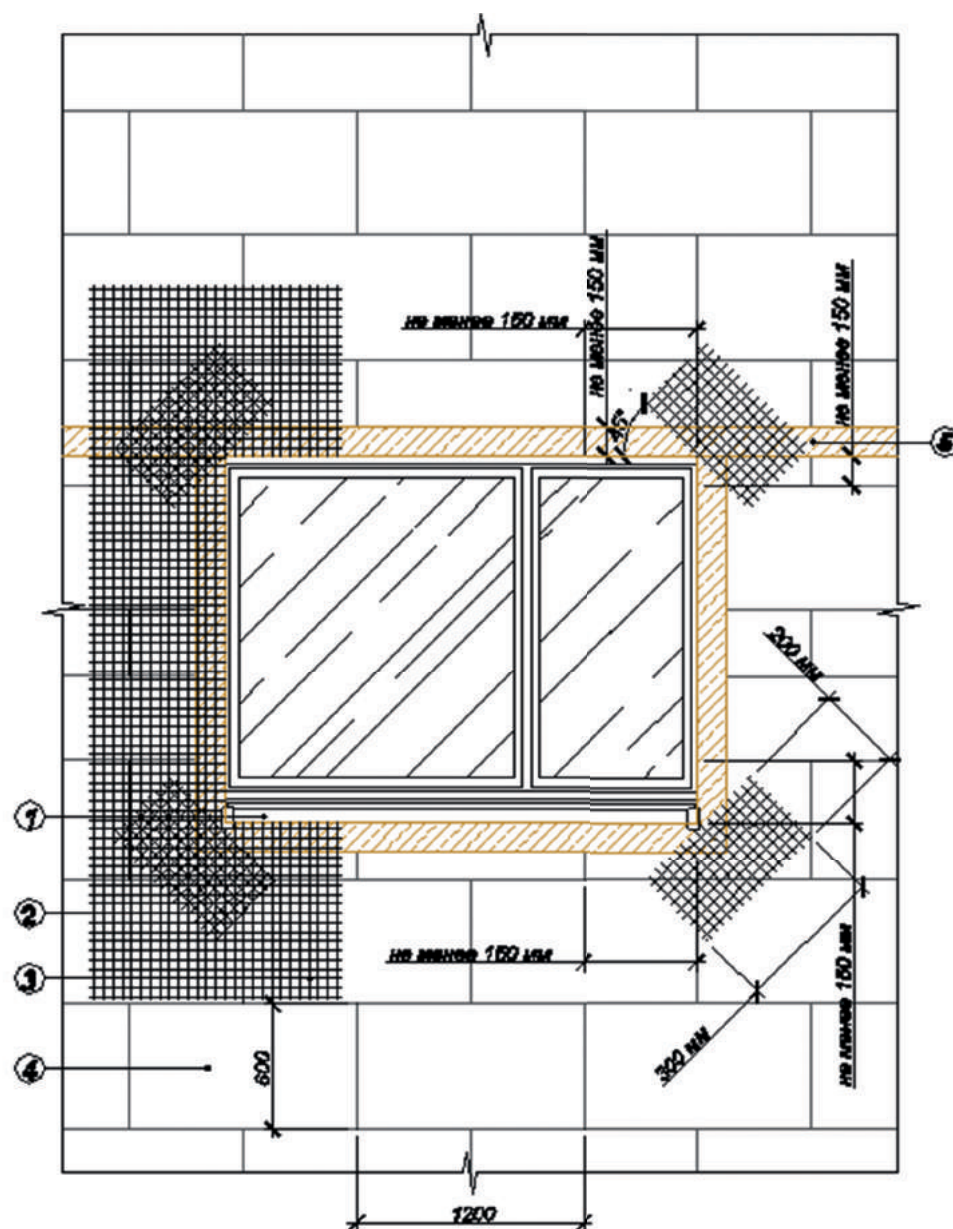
Схема монтажа теплоизоляционных плит вокруг проемов
